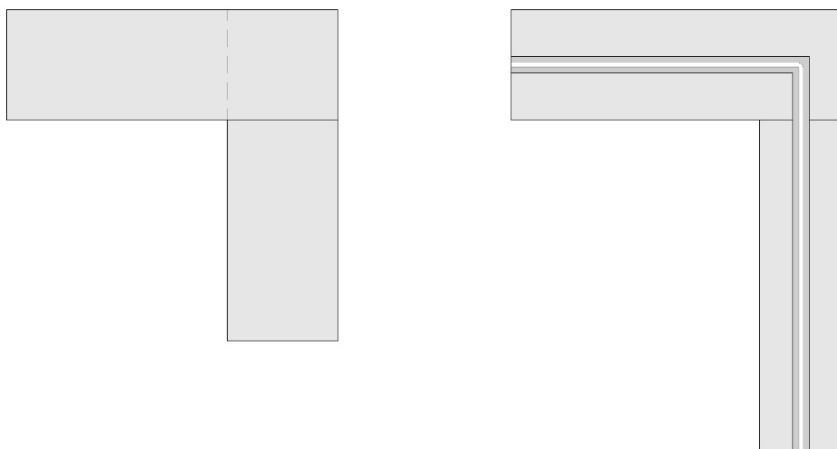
, corte horizontal, encuentro de muros: de igual espesor se traba en la elevación, de distinto espesor se arma c/3 hiladas con varilla en L en canaleta en ambos bloques
